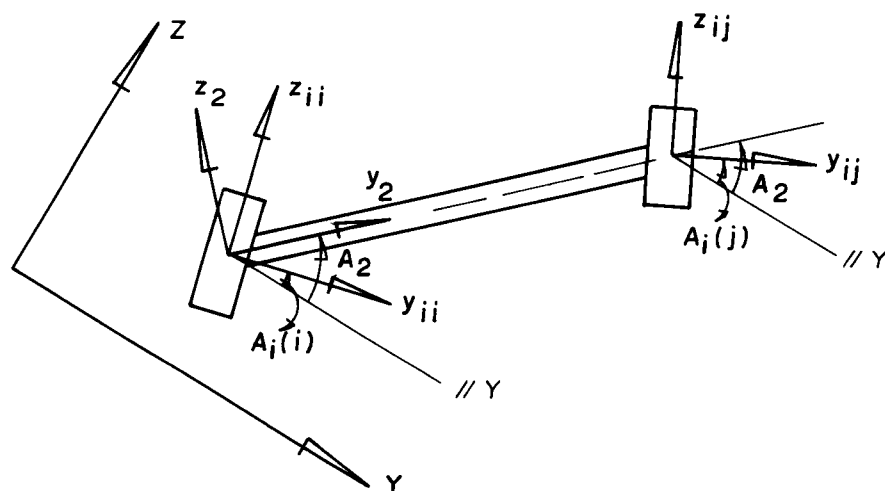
Viga pilar-pilar e pilares individuais: relação entre sistemas de referência.
